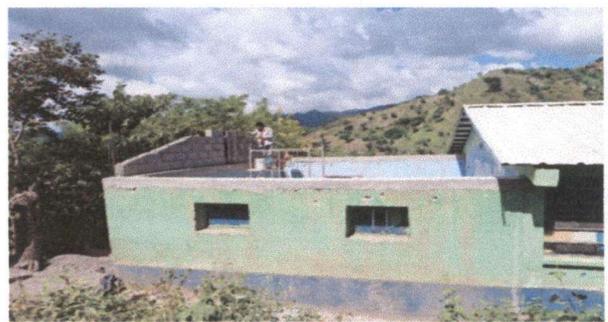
Levantado de la pared para instalar la estructura y lámina.
